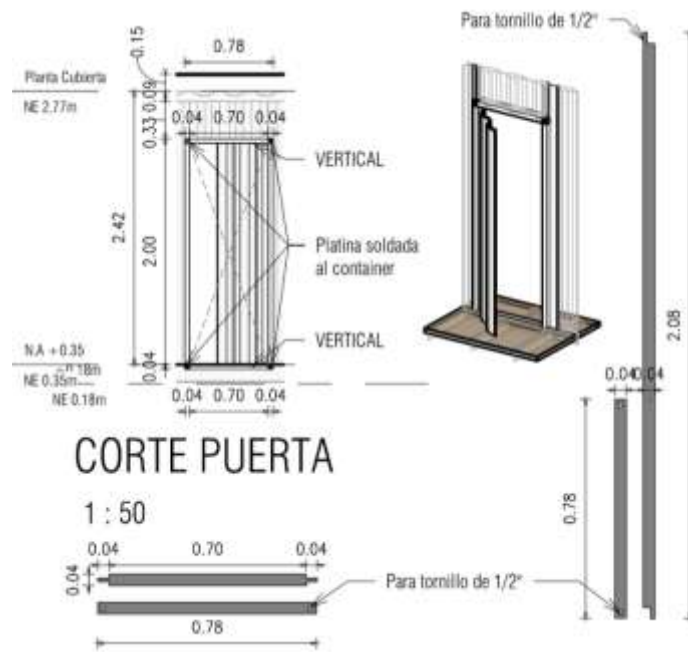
, Detalle puerta, 2025-II, Wilson Lozano
